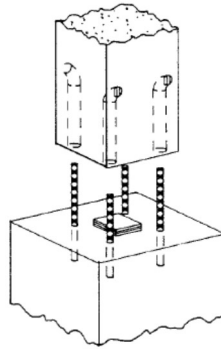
Ligação com chumbadores cravados com argamassa não retrátil (Levy, 2000)
